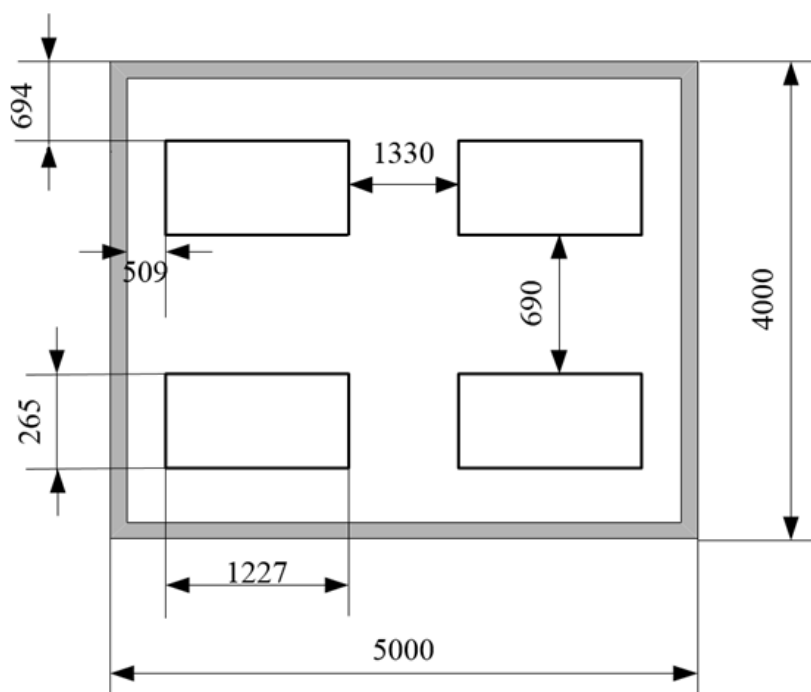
План помещения и размещения светильников с люминесцентными лампами
